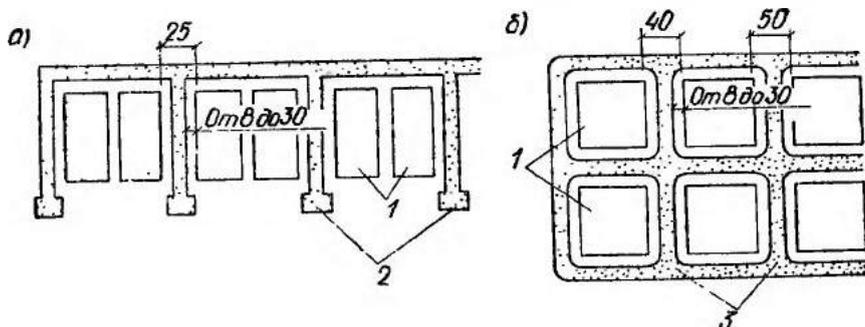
Планировка склада круглых лесоматериалов (размеры даны в метрах)
